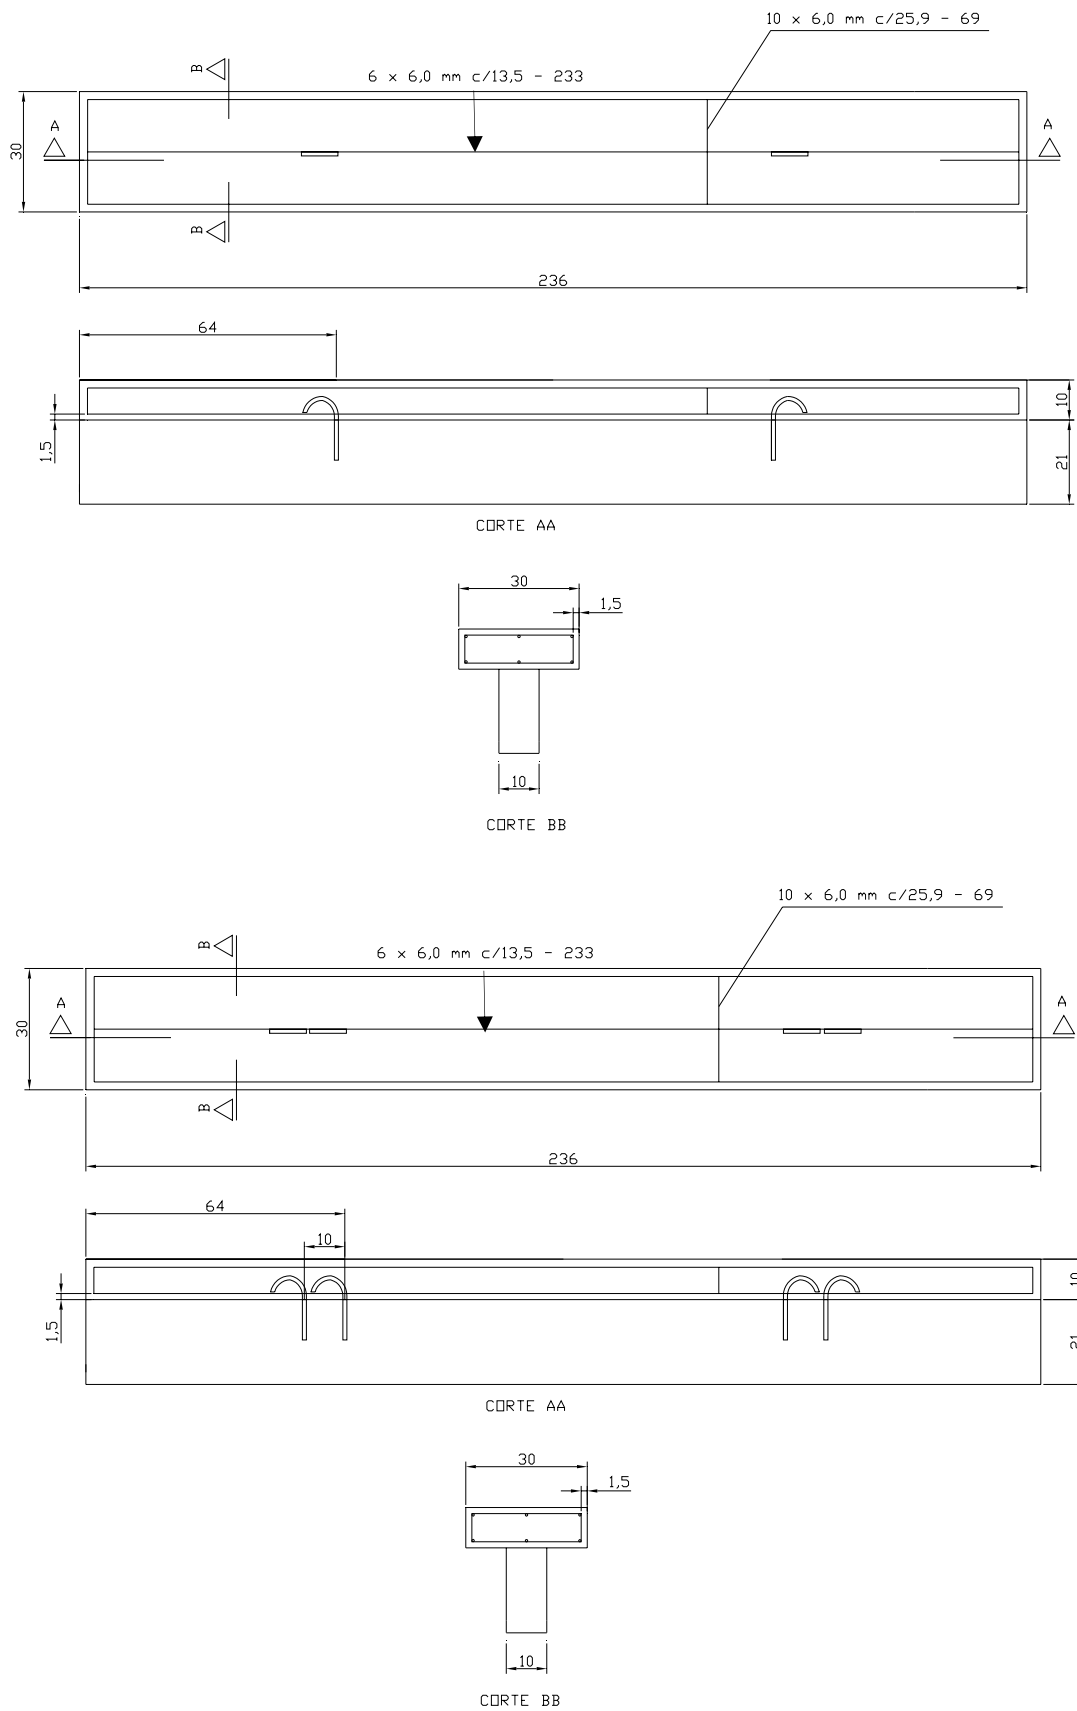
Vigas mistas com 2 e 4 conectores de 10,0 mm
